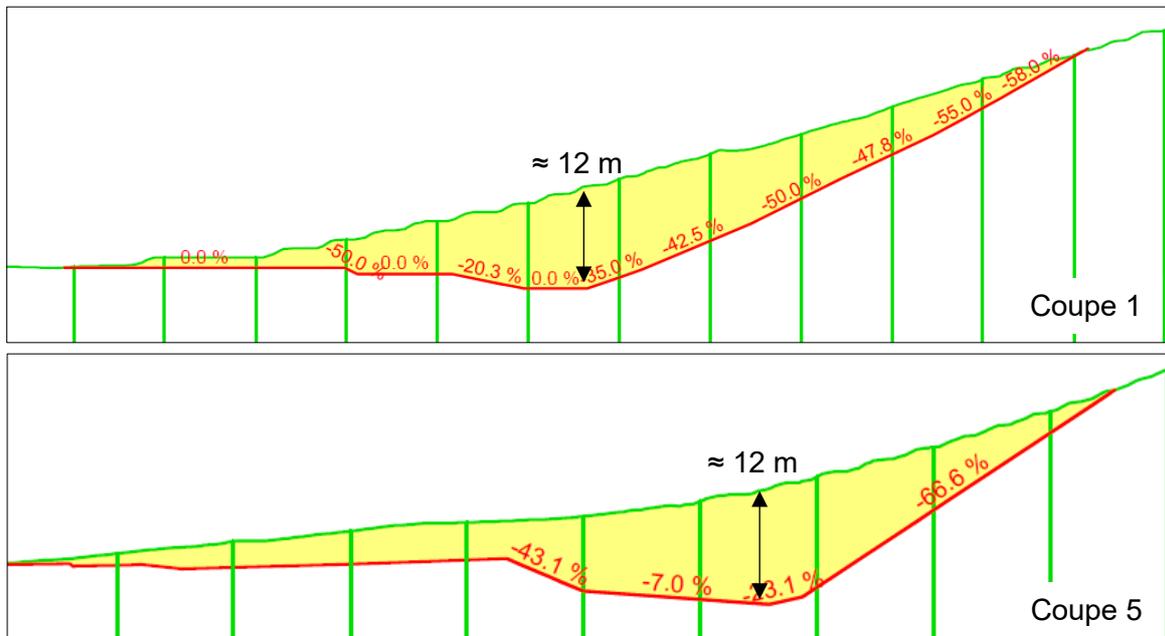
Extraits Coupe n°1 (axe de la TC) et Coupe n°5
